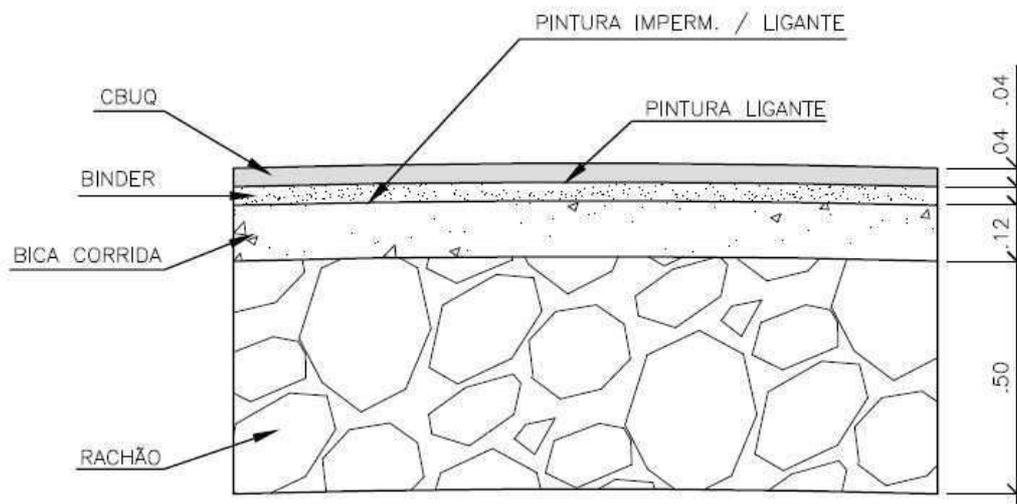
Detalhe executivo da pavimentação, conforme desenho de projeto “como construído” nº AB-003-R0.
